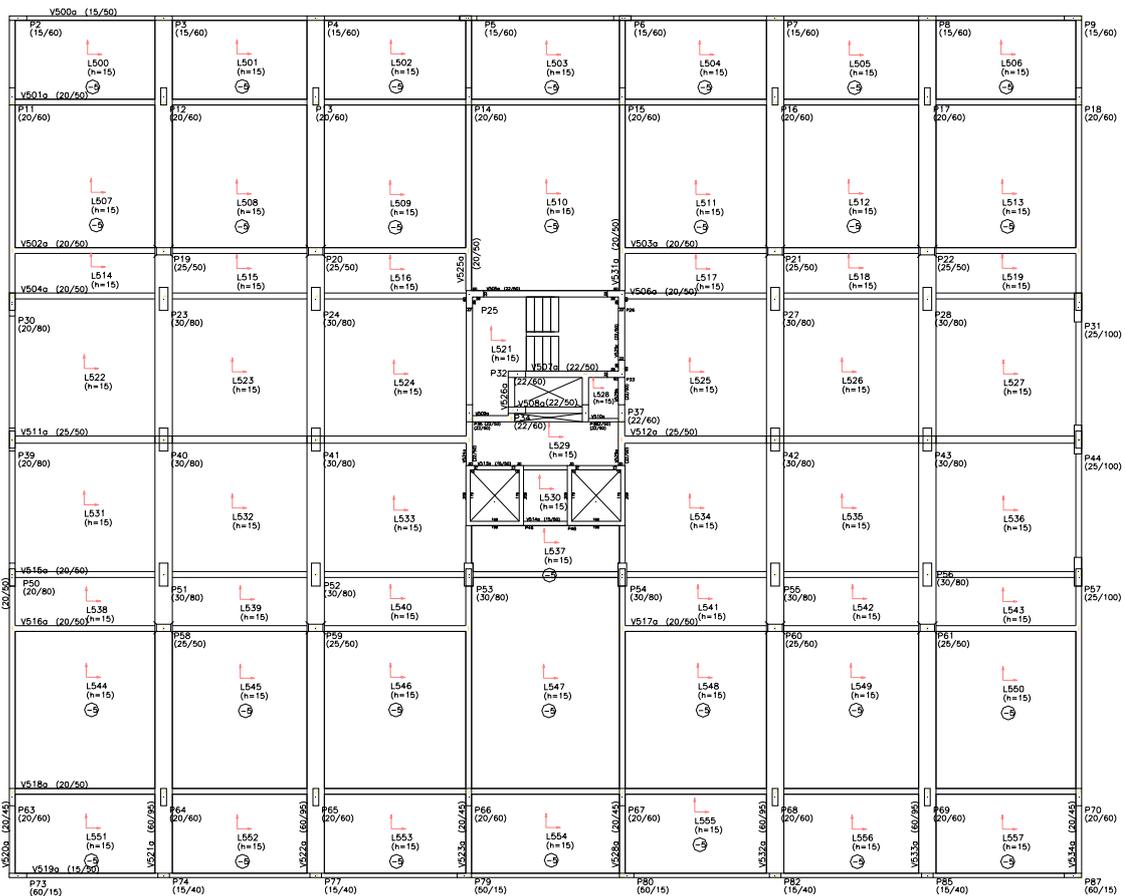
Planta baixa do pavimento 01 do Edifício 02
